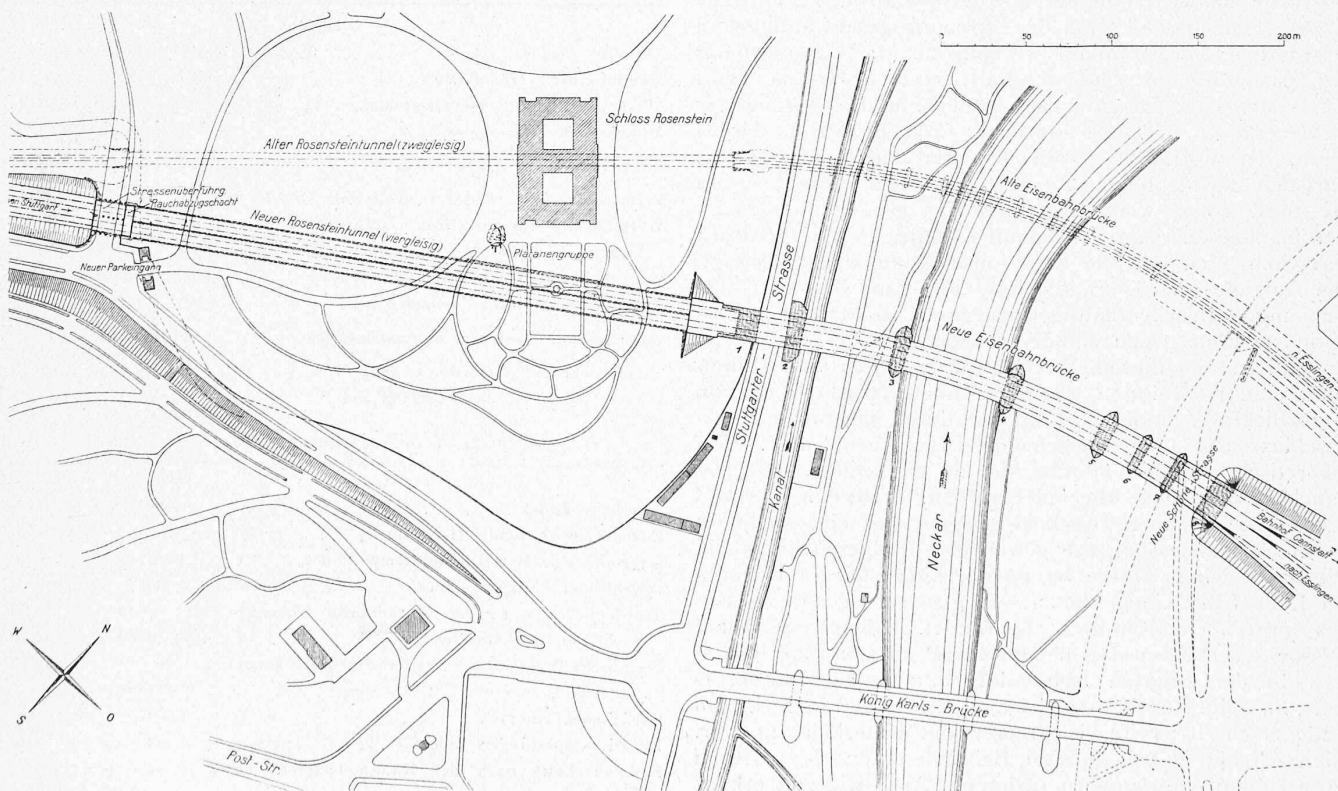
Lageplan der alten und der neuen Bauwerke Rosensteintunnel und Neckarbrücke bei Cannstatt. — Masstab 1:4000.
